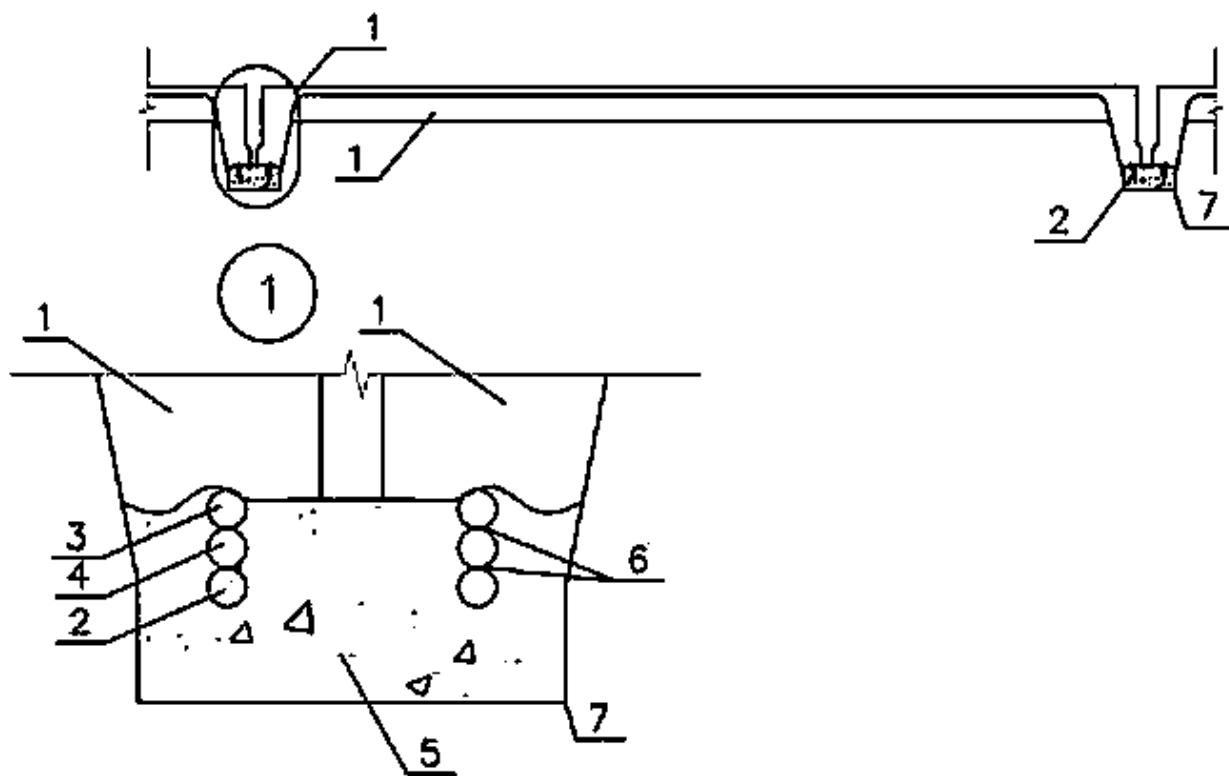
Установка дополнительной арматуры в растянутой зоне
